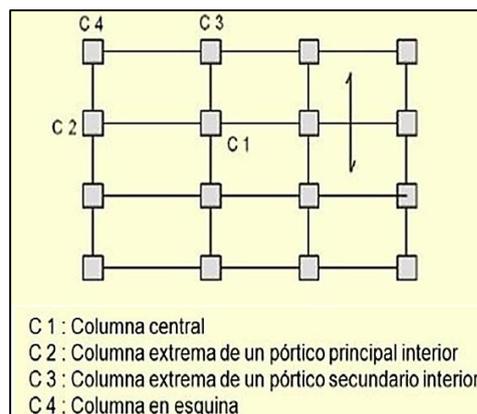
UBICACIÓN DE ZAPATAS Y COLUMNAS
